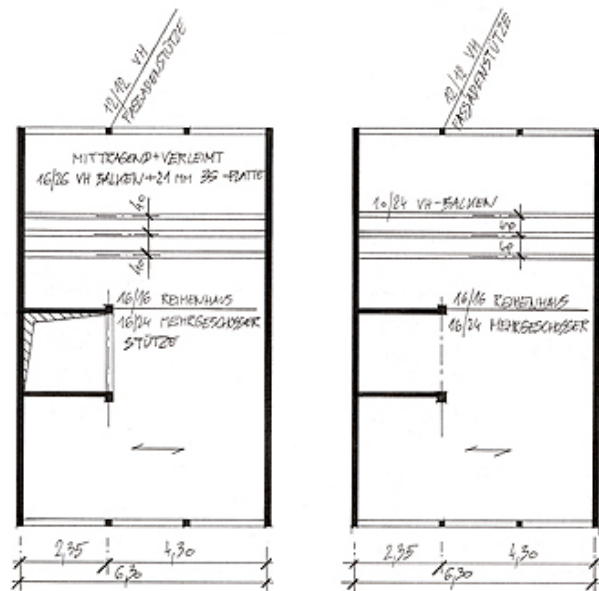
Variantengrundrisse vom Tragwerk Reihenhaus-schmal und Mehrgeschosser Zwischendecke und Dach mit Überbrückung der gesamten Spannweite, innere Stützenquerschnitte müssen bei Mehrgeschosser erhöht werden
